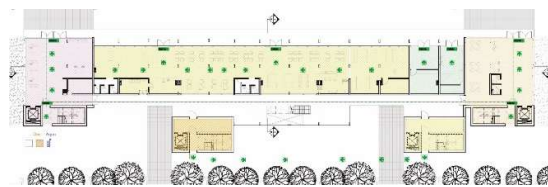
Planta Baja – Sector comercial, residencial y estacionamiento
